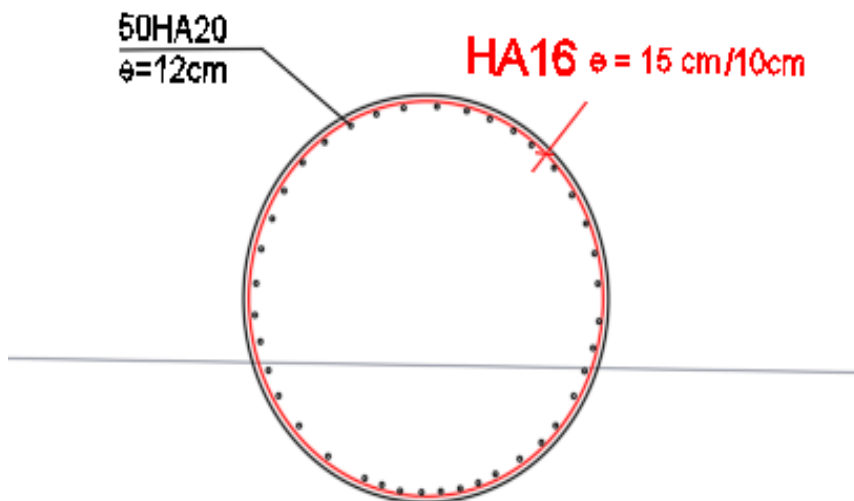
ferrailage d'un fut de la pile 1
